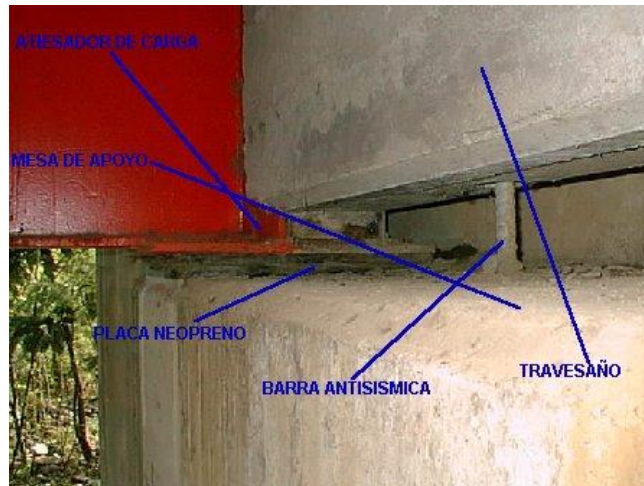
Estribo sin viga diafragma entre el muro de respaldo y las vigas
